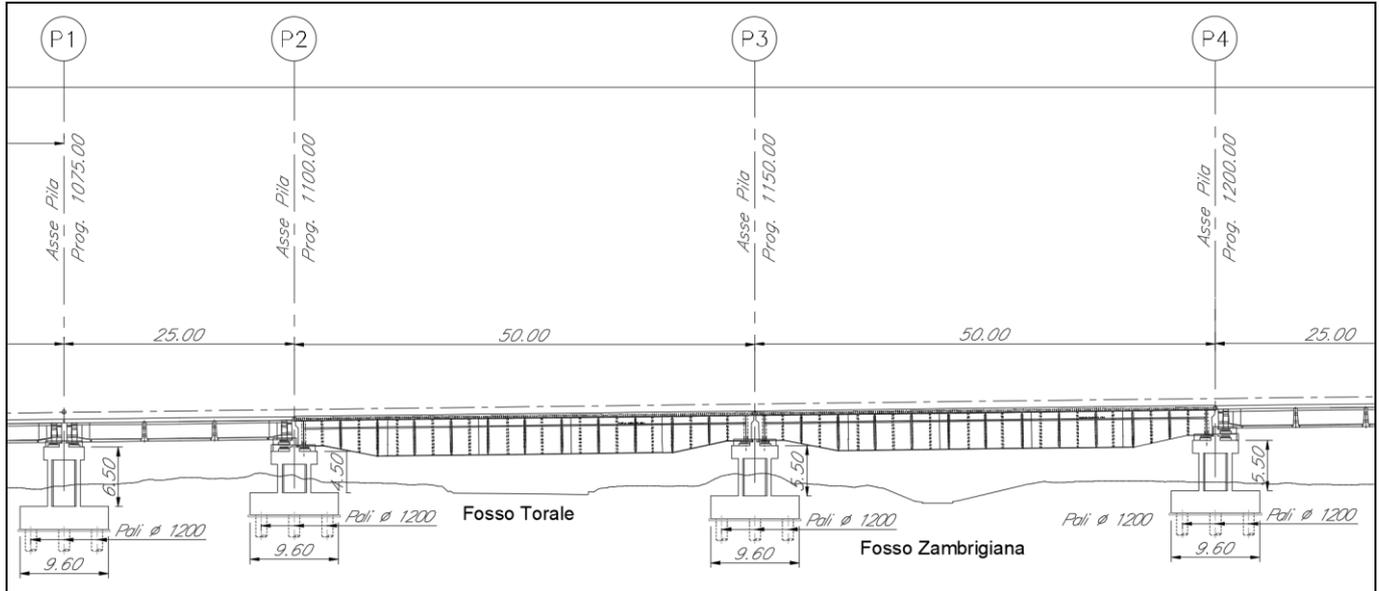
Stralcio del prospetto del viadotto VI05 in corrispondenza dell'attraversamento dei fossi Torale e Zambrigliana.
